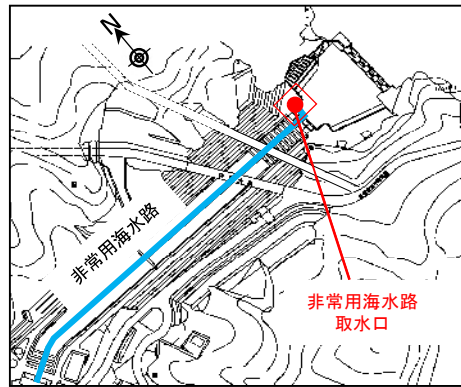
海水取水トンネル呑み口平面図・断面図
